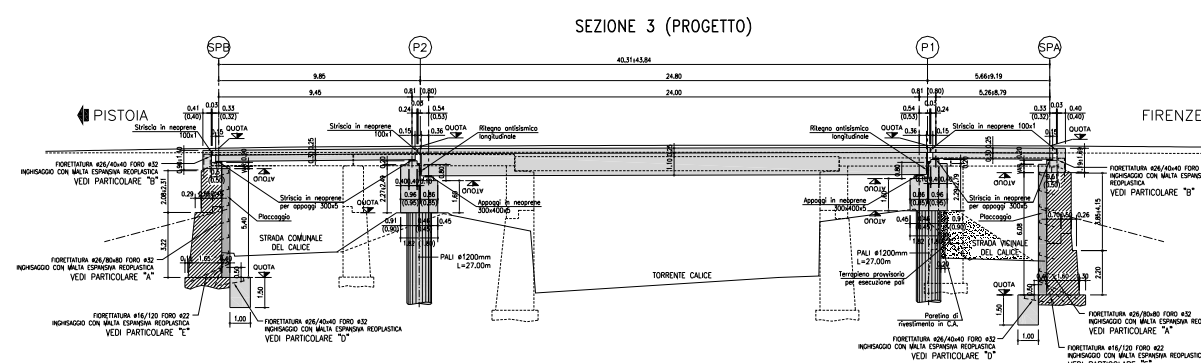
Sezione longitudinale impalcato di nuova realizzazione
